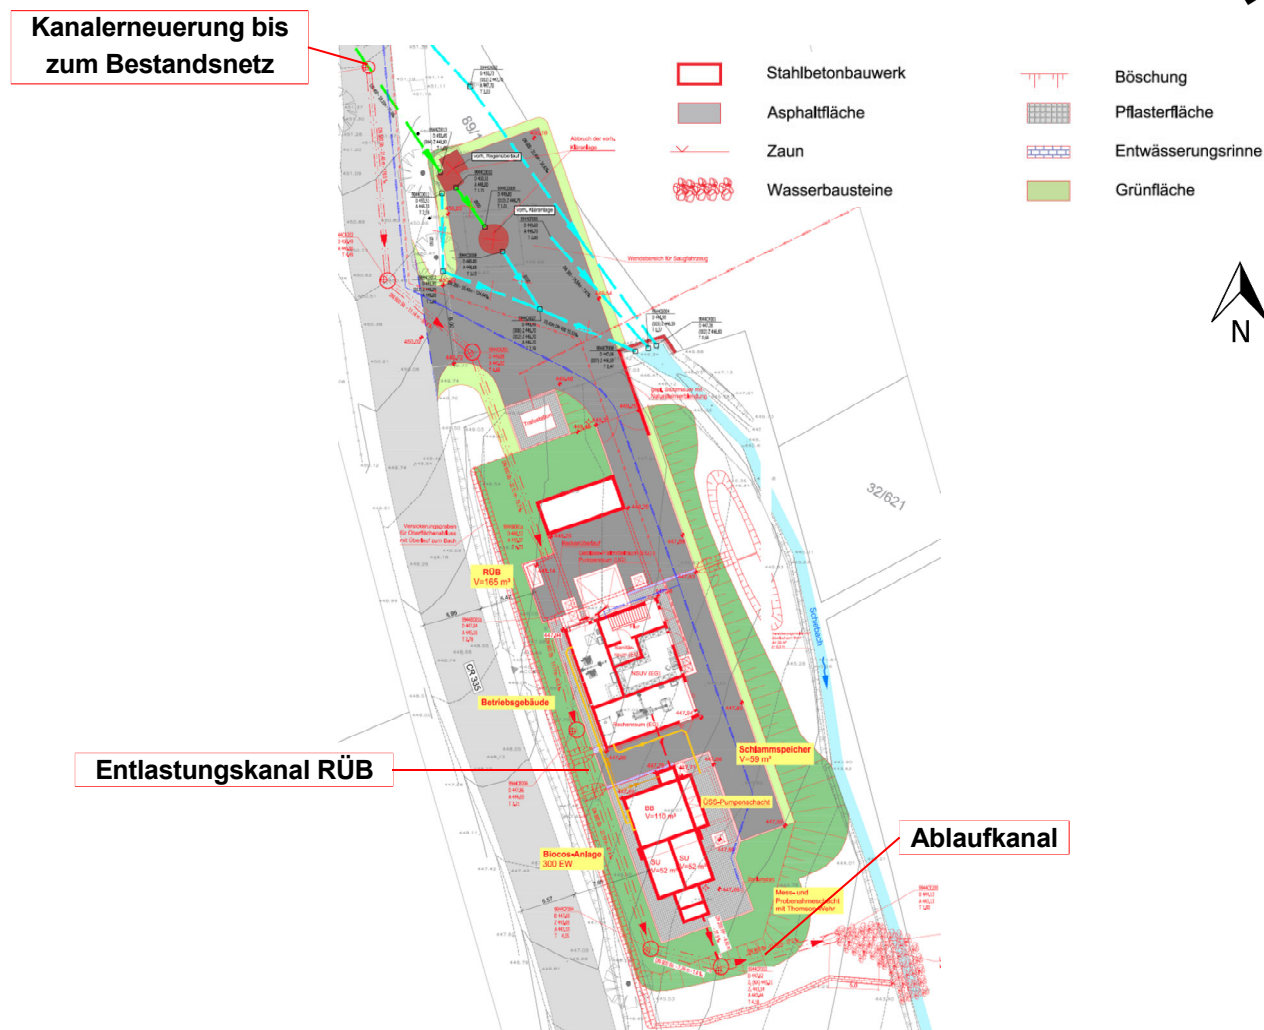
Ausschnitt Übersichtslageplan der Kläranlage
